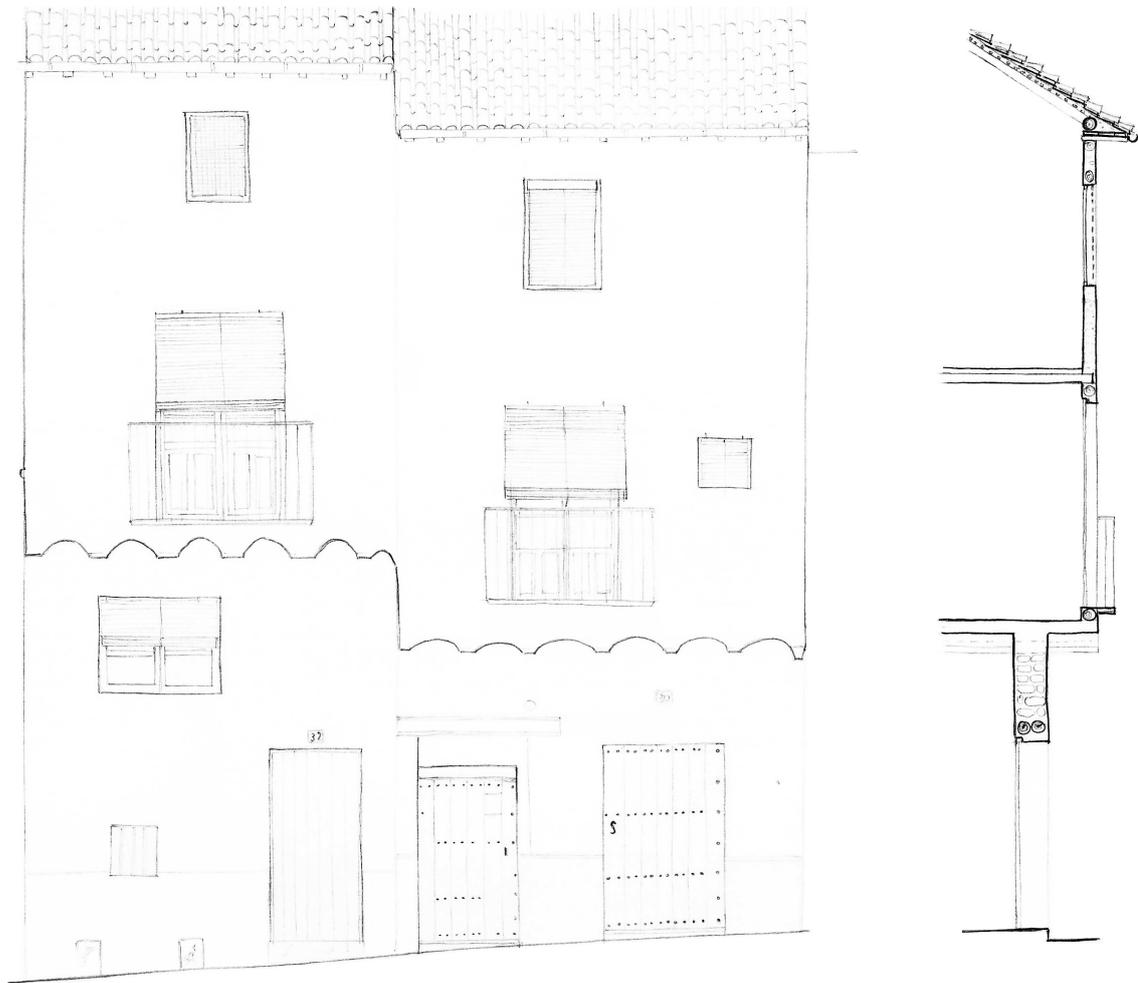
Fachada y sección edificio calle Santa Engracia (Montalbán)
